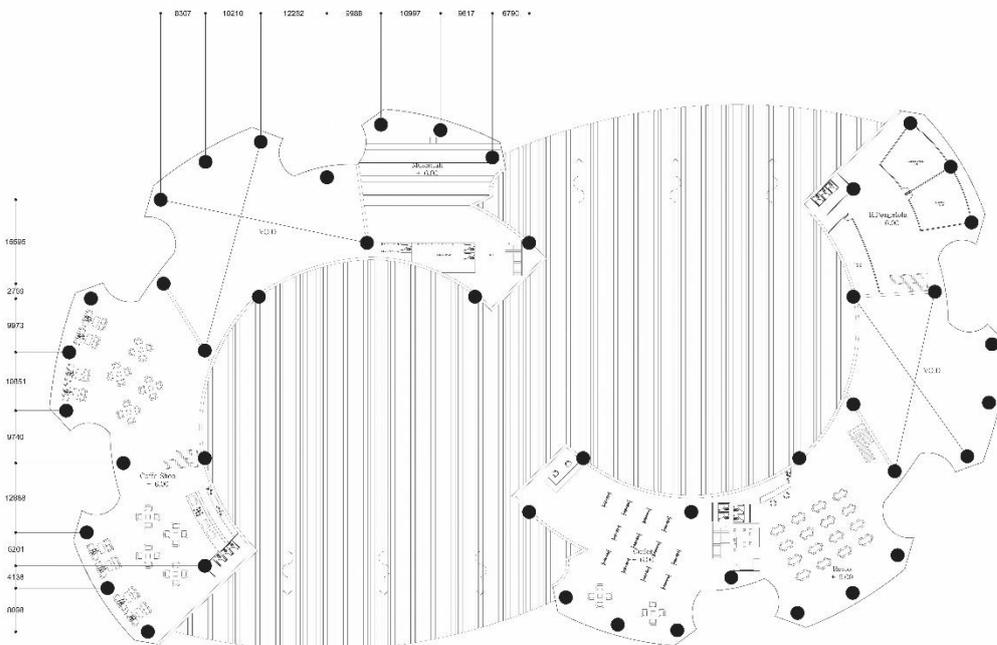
Denah Lantai Dasar (Sumber: Analisa Pribad, 2017)
